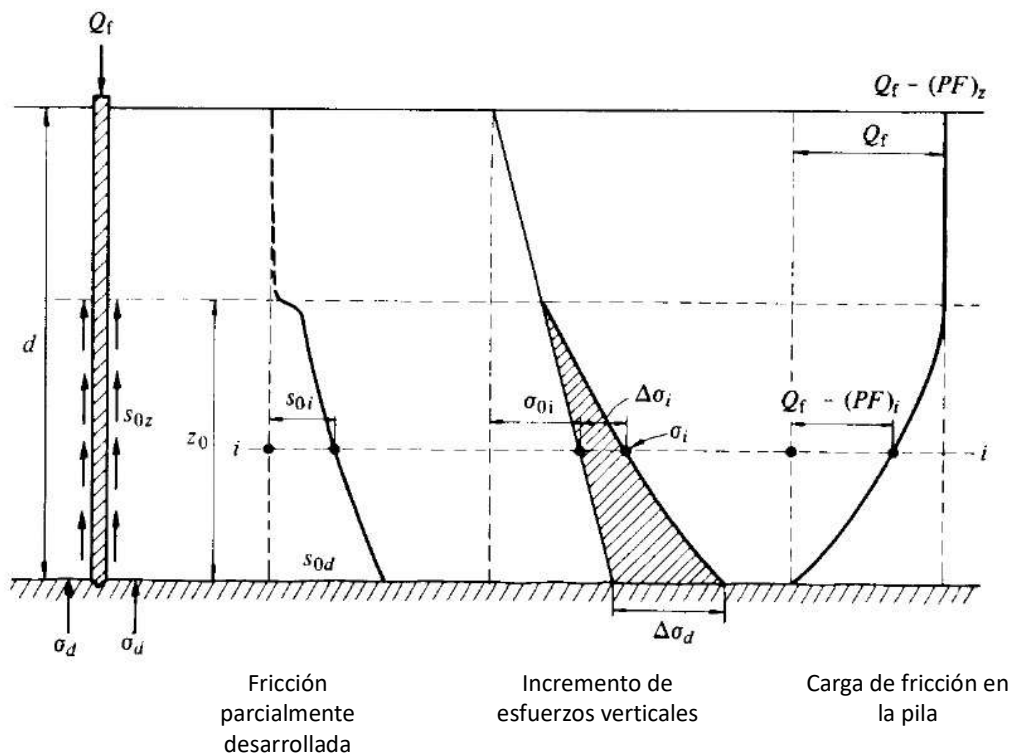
Distribución de carga, esfuerzos y esfuerzo cortante en la pila, para pilotes de fricción; adaptado de Zeevaert (1983).
